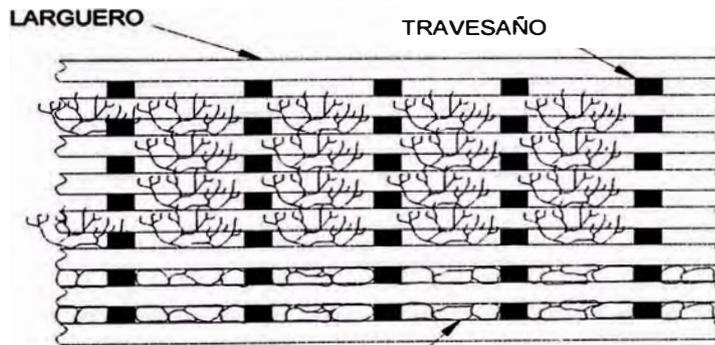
(a) : Muro Viviente – Perspectiva
